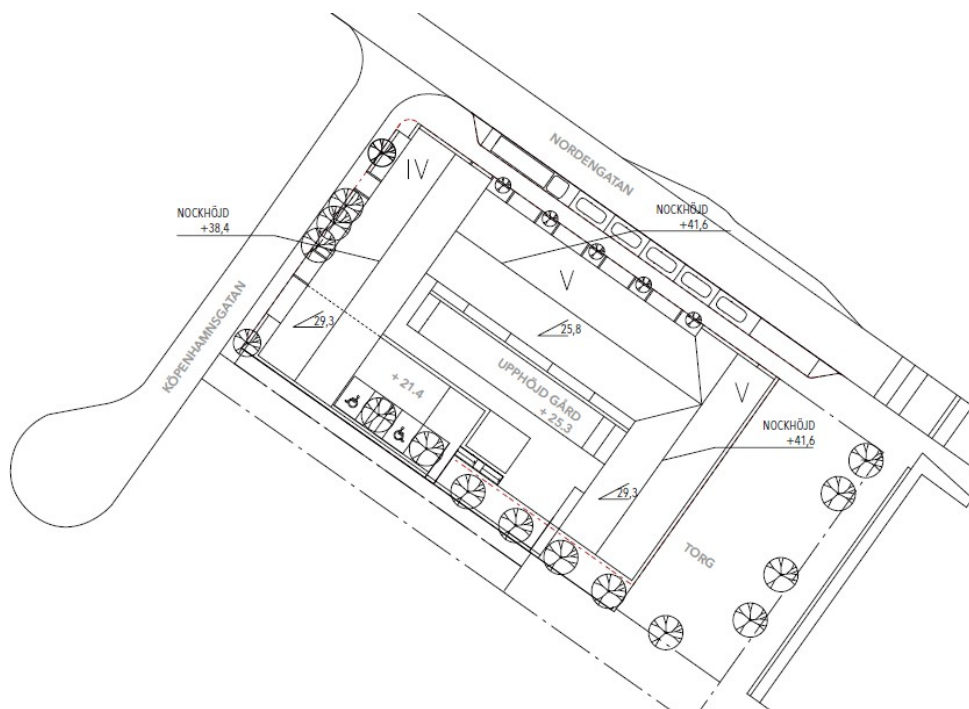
Den tilltänka bebyggelsens nockhöjd, taklutning och våningsantal. Observera att nockhöjderna är något lägre än detaljplanens högst tillåtna nivåer som är avrundade till närmaste halvmeter för att ge en viss flexibilitet. DinellJohansson
